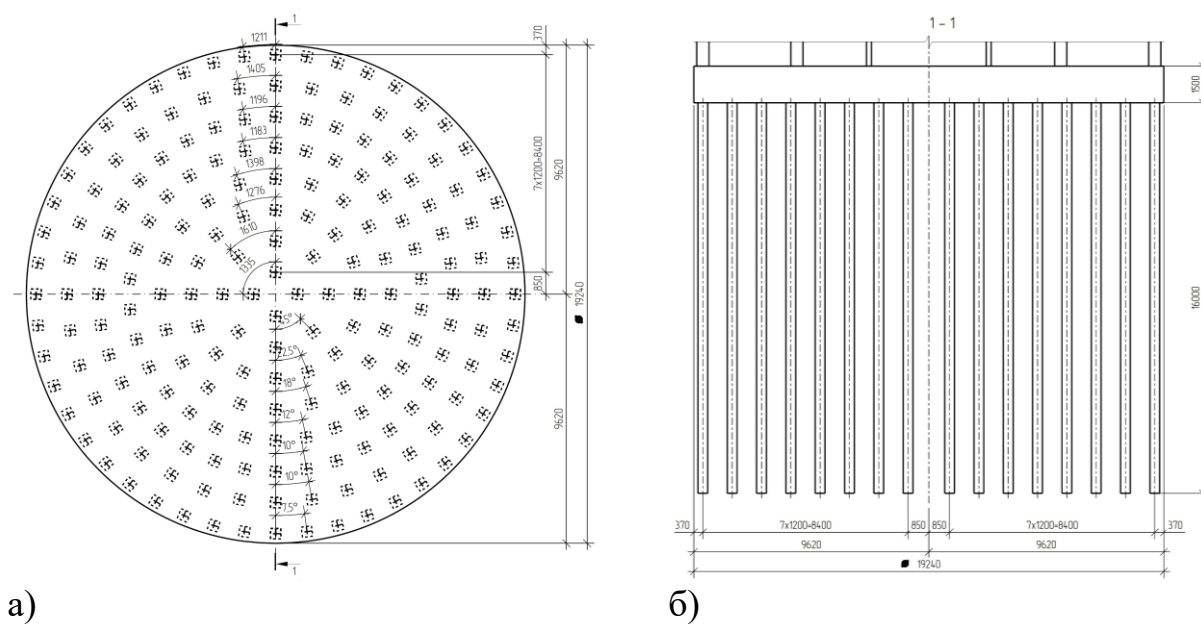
Фундамент здания: а) план; б) разрез
